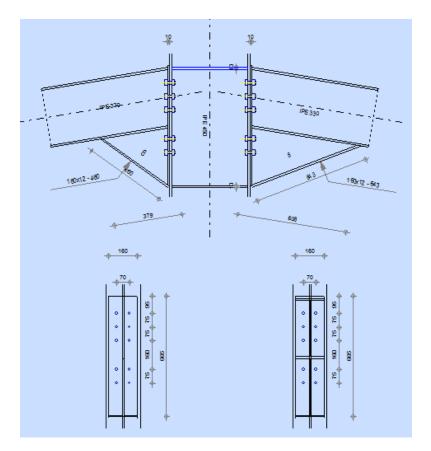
Schéma d'assemblage (traverse-traverse)
